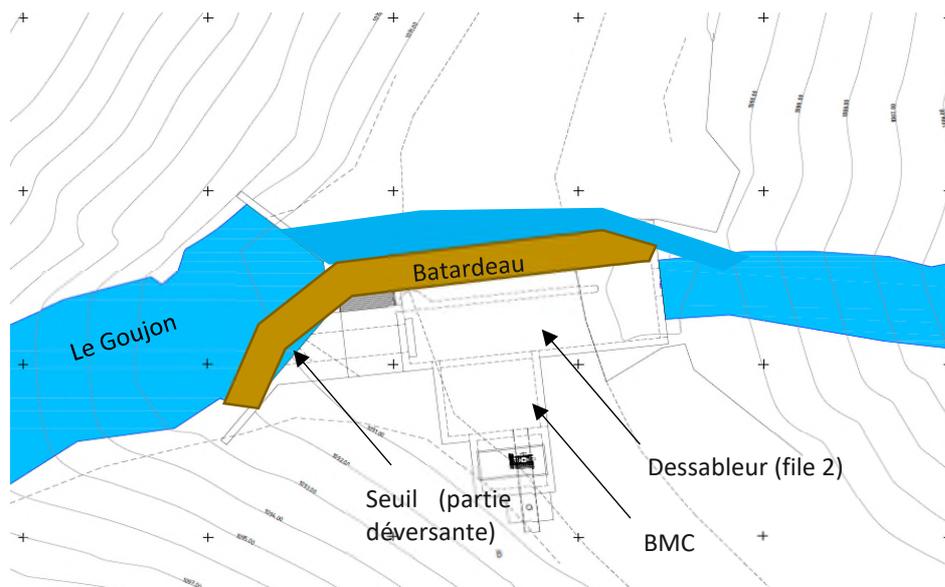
Travaux de construction de la prise d'eau – Phase 1
